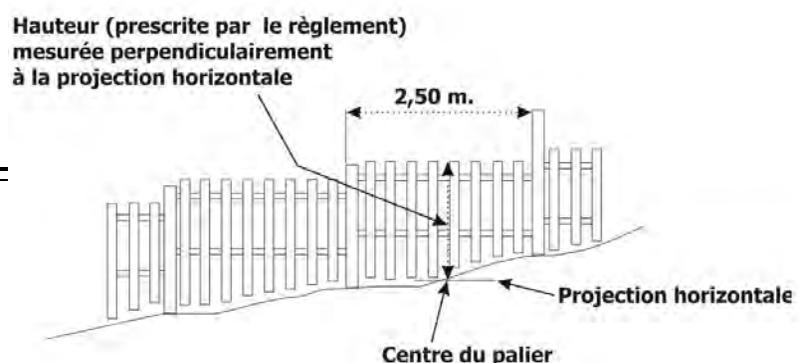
Hauteur autorisée pour une clôture ou muret selon sa localisation
